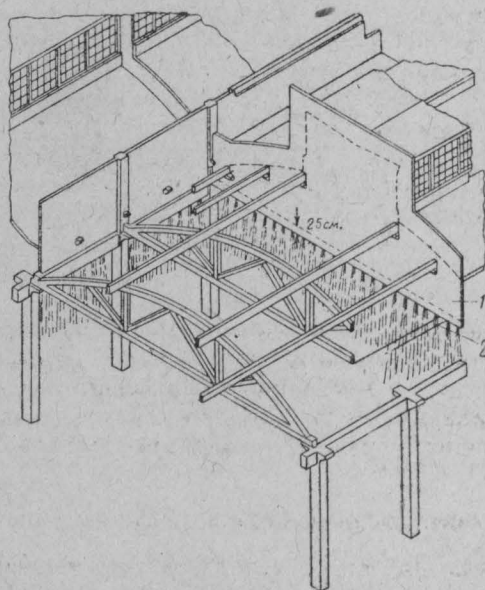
Огнестойкая железобетонная монолитная перегородка.
